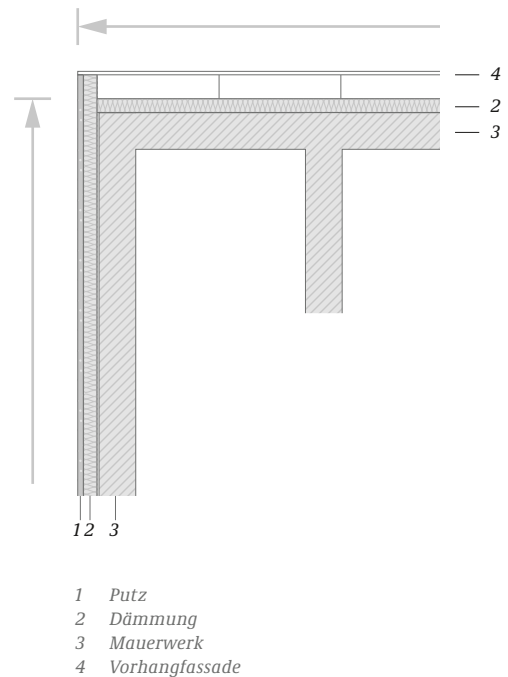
Grundriss, horizontales Aufmaß
